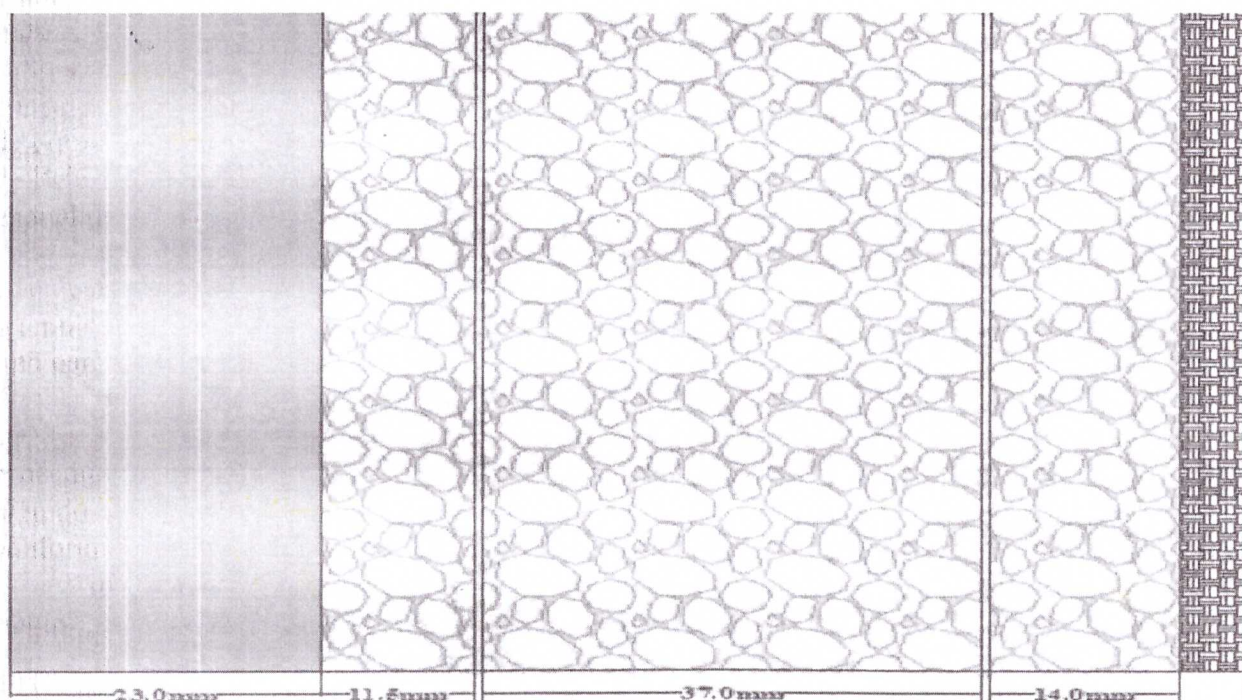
Pannello termo isolante tipo sandwich EDILPANEL – REISOHT
